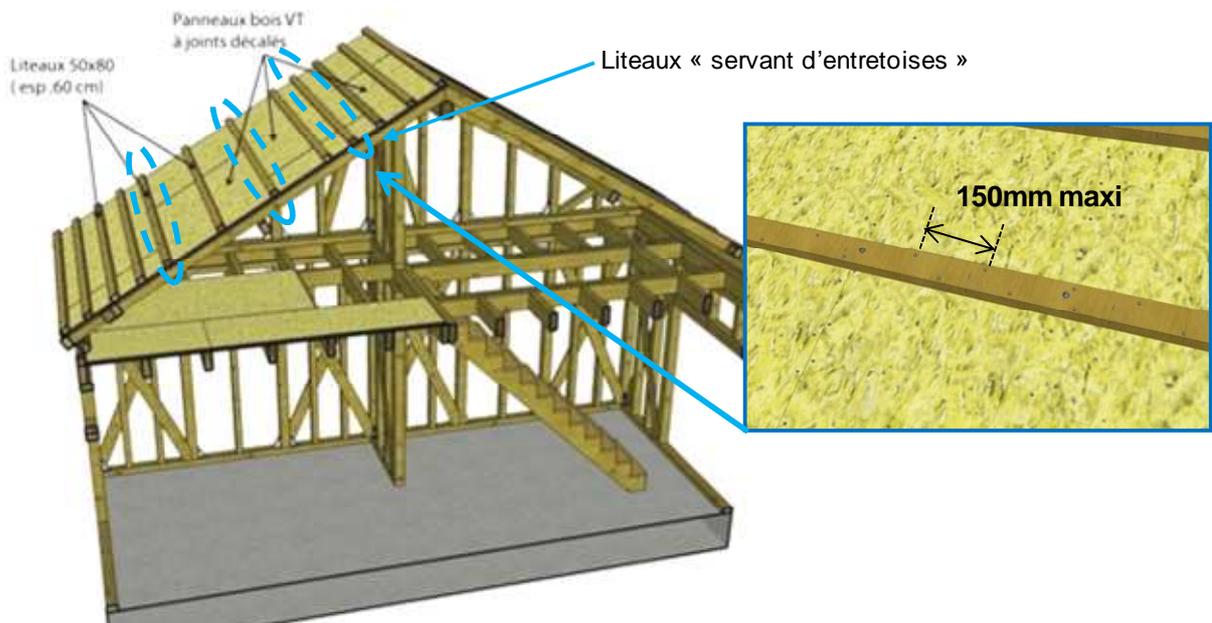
Diaphragme horizontal en toiture de type voiles travaillant sur charpente avec chevron
